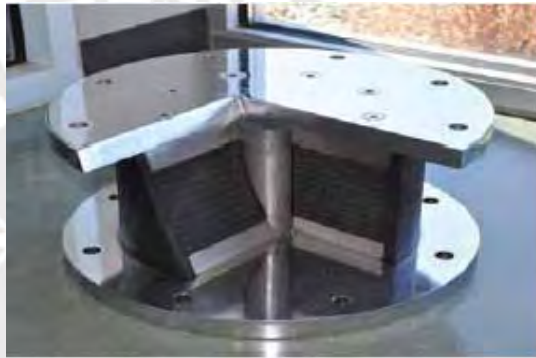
Aislador elastómero con núcleo de plomo. (Cámara Chilena de la Construcción, 2011)
